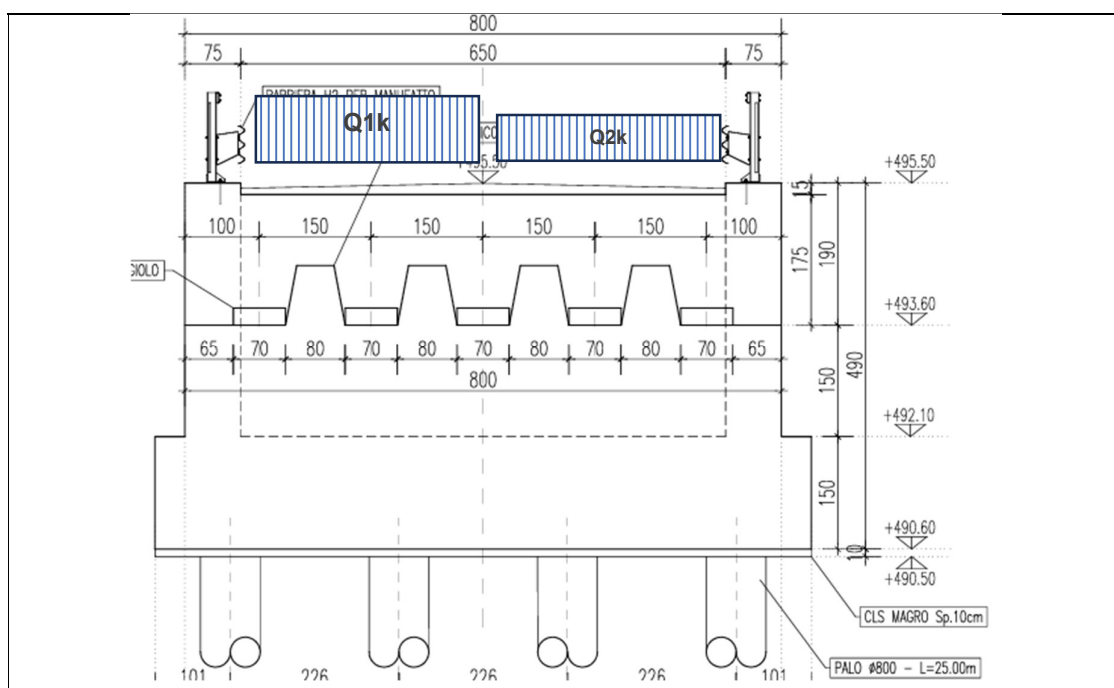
Modello di carico - sezione trasversale spalla
